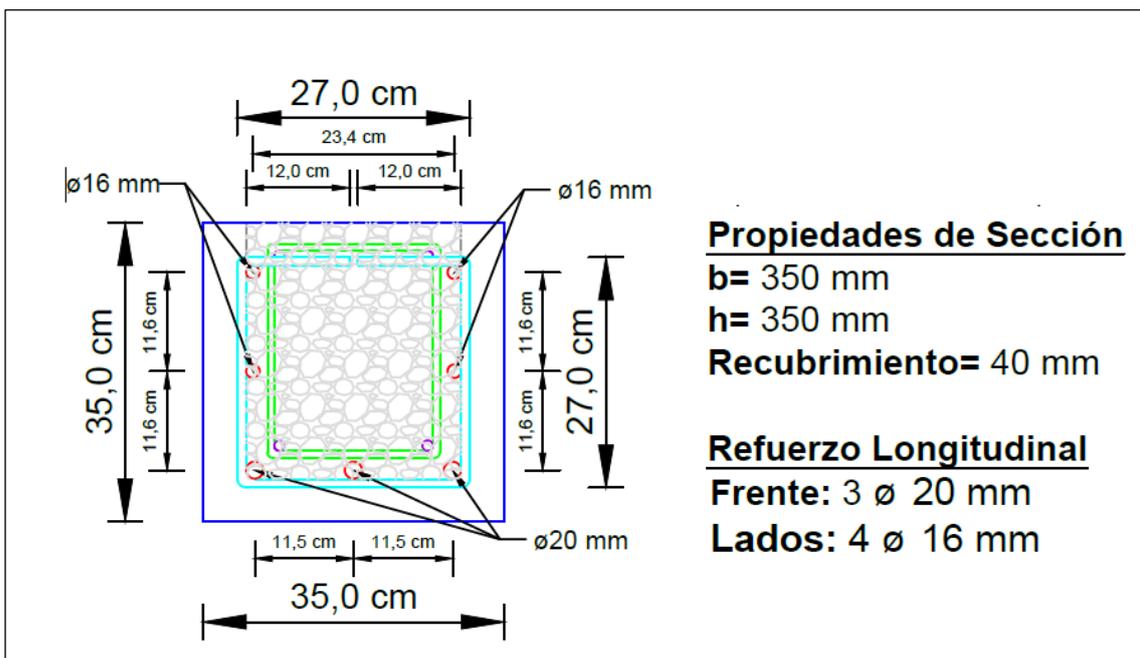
Columna de Borde de Piso 2: Armado de encamisado.
